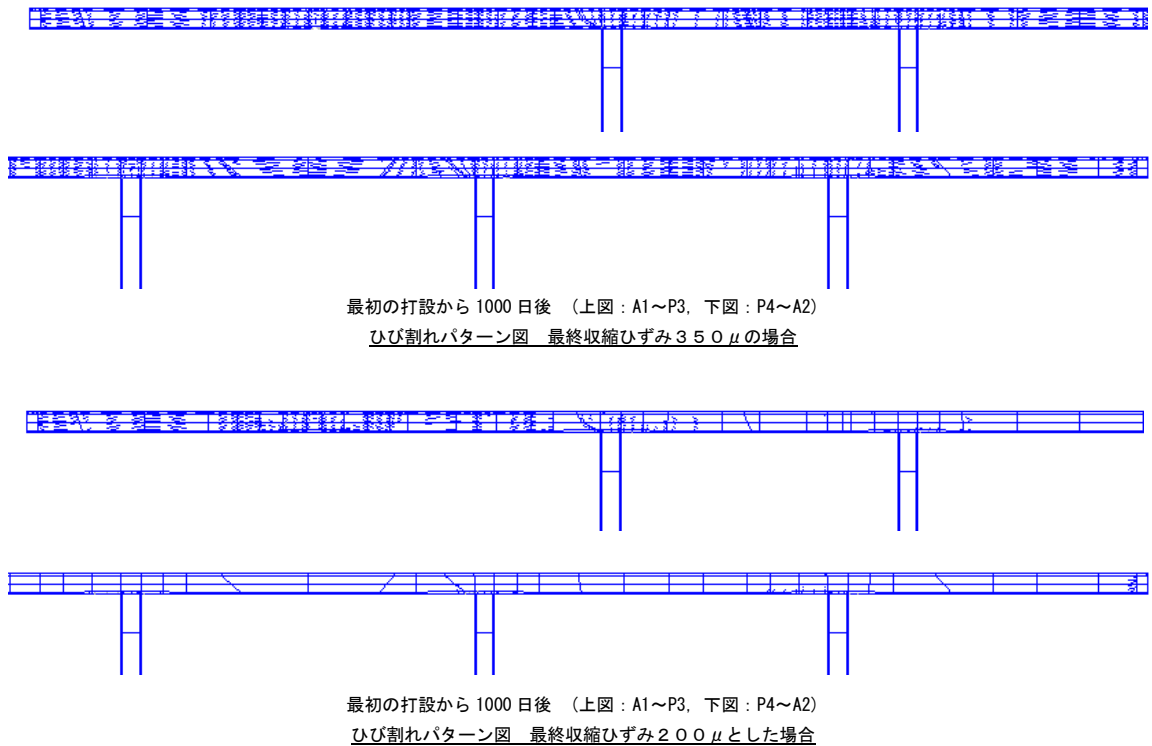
コンクリートの収縮量によるひび割れのちがい
